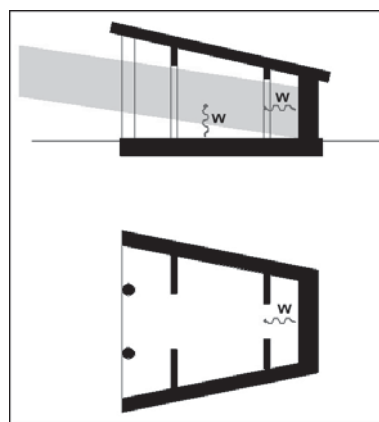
Megaron im Winter (Längsschnitt und Grundriss)
